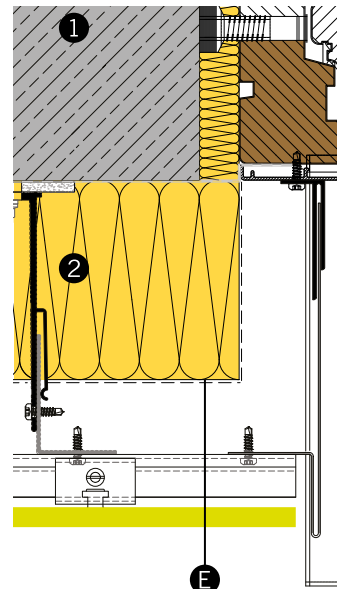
DETAILLERING: HORIZONTALE DOORSNEDES SYSTEEM PM03
